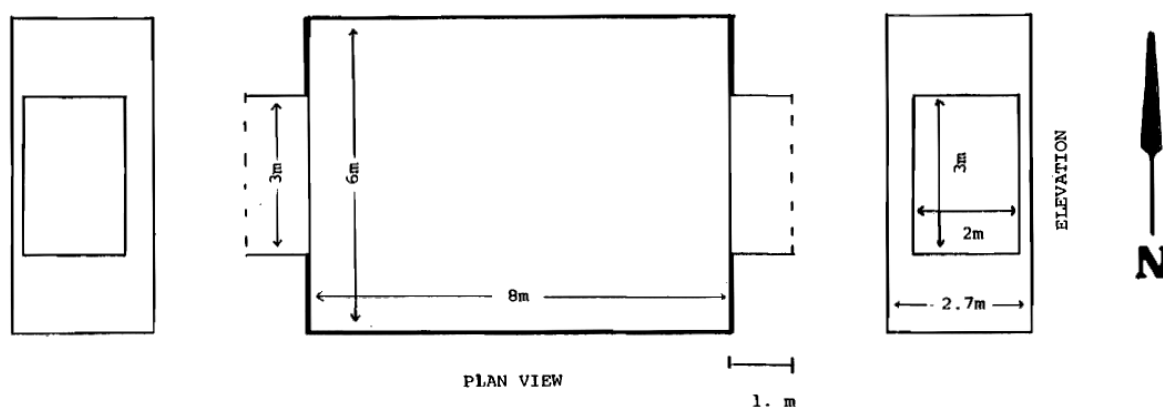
BESTEST: vista in pianta con finestre ombreggiate ad est e ad ovest
